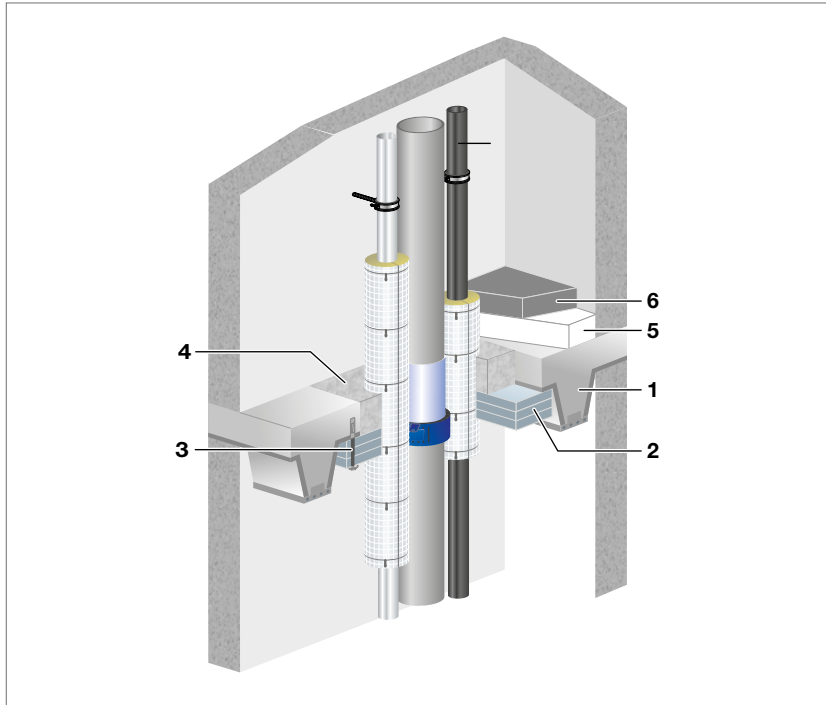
Stahlbeton- und Spannbeton-Rippendecken bzw. Plattenbalkendecken aus Normalbeton bzw. Leichtbeton mit geschlossenem Gefüge nach DIN 4219-1 und -2 ohne Zwischenbauteile – „F 30-, F 60-, F 90“-Konstruktion
